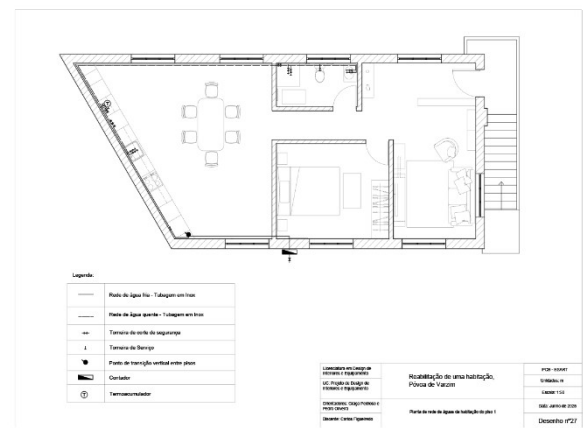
Planta de Pavimentos Habitação Piso 1. Fonte: Autor.
